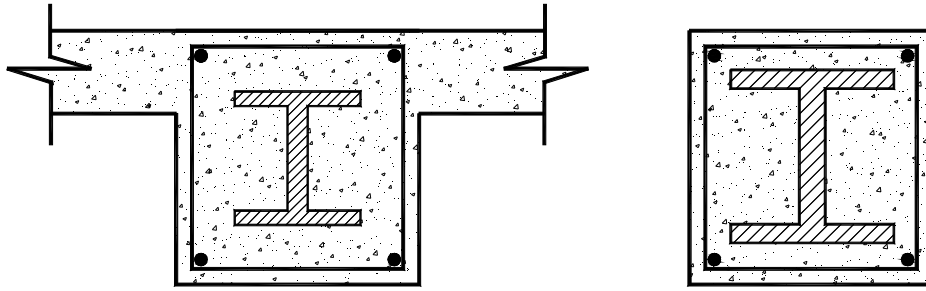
Perfis soldados de aço embutidos em viga e pilar de concreto armado
